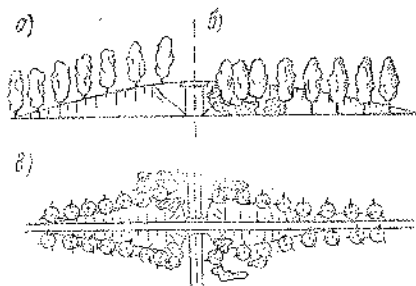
Декоративные посадки у насыпи на подходах к путепроводу:
